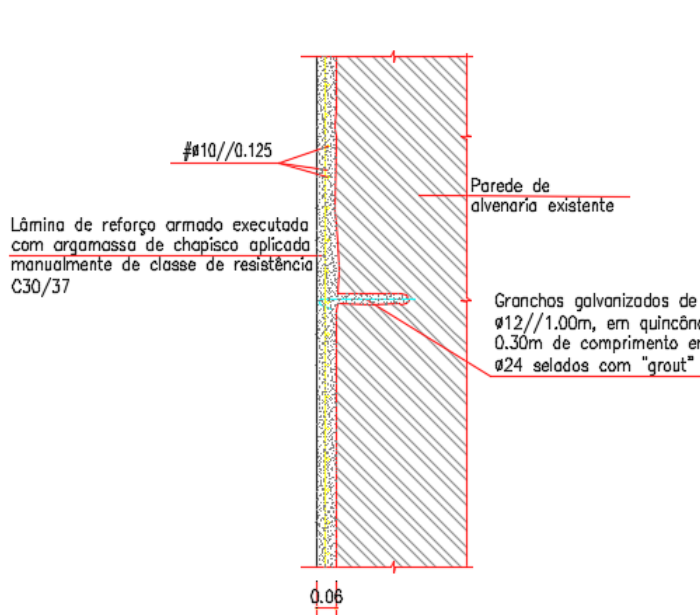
Pormenor do reforço das alvenarias de fachada
